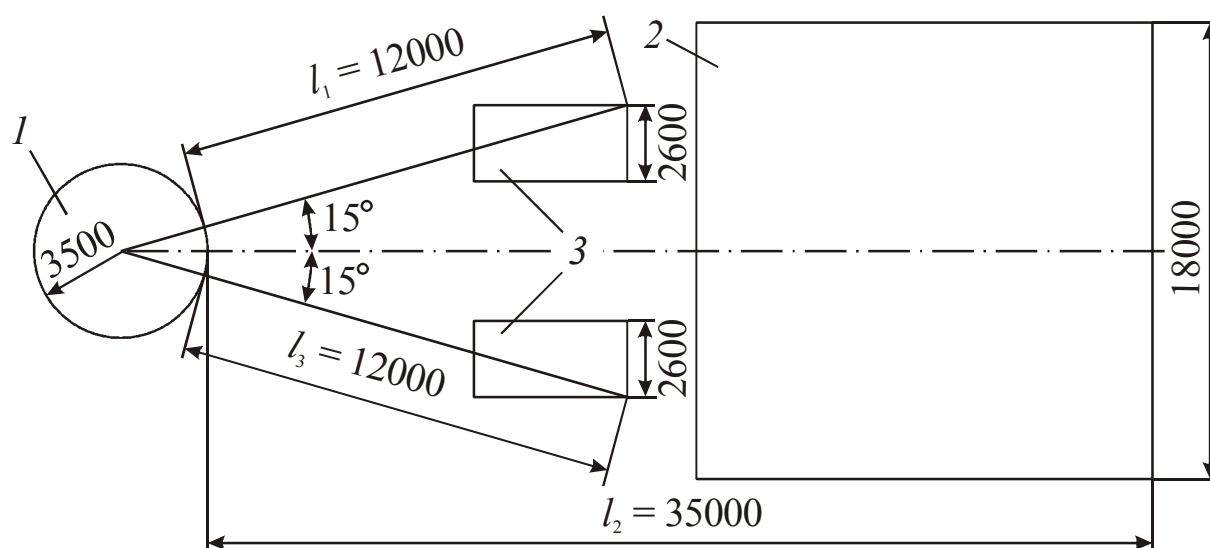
Схема к расчету пригрузок от поверхностных сооружений: 1 – ствол; 2 – здание; 3 – укосины
